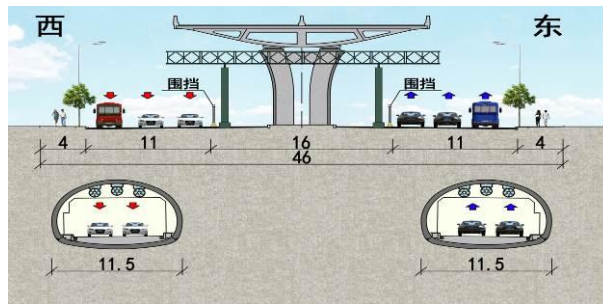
重庆路双向八车道段主线桥梁上部结构施工调流断面图
